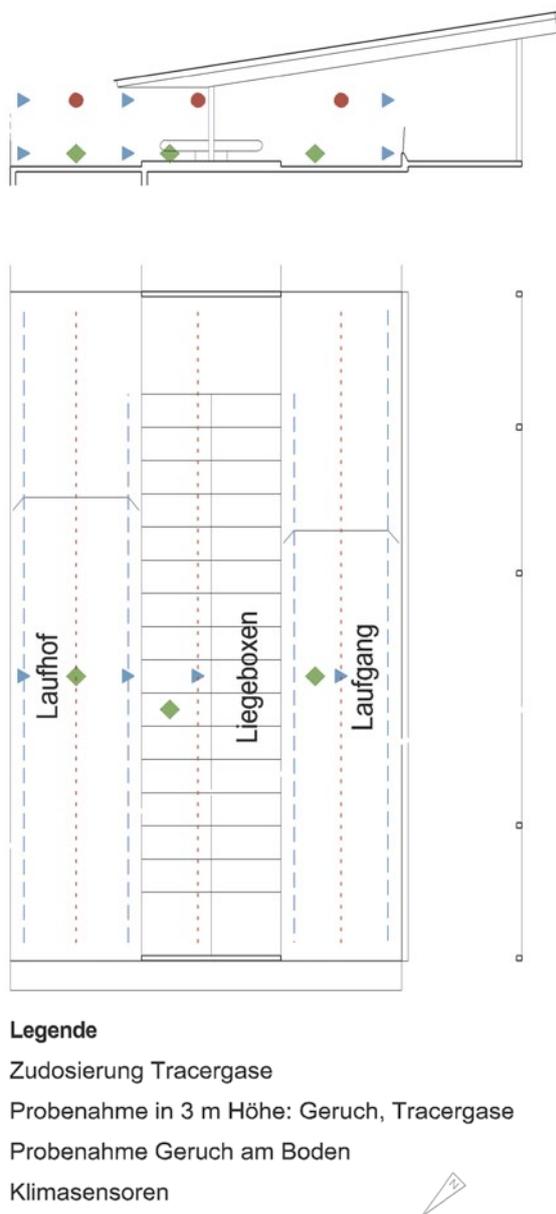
| Schematische Darstellung mit Grundriss und Schnitt eines zweireihigen Liegeboxenlaufstalls mit Zudosierung, Probenahme sowie Klimasensoren.
